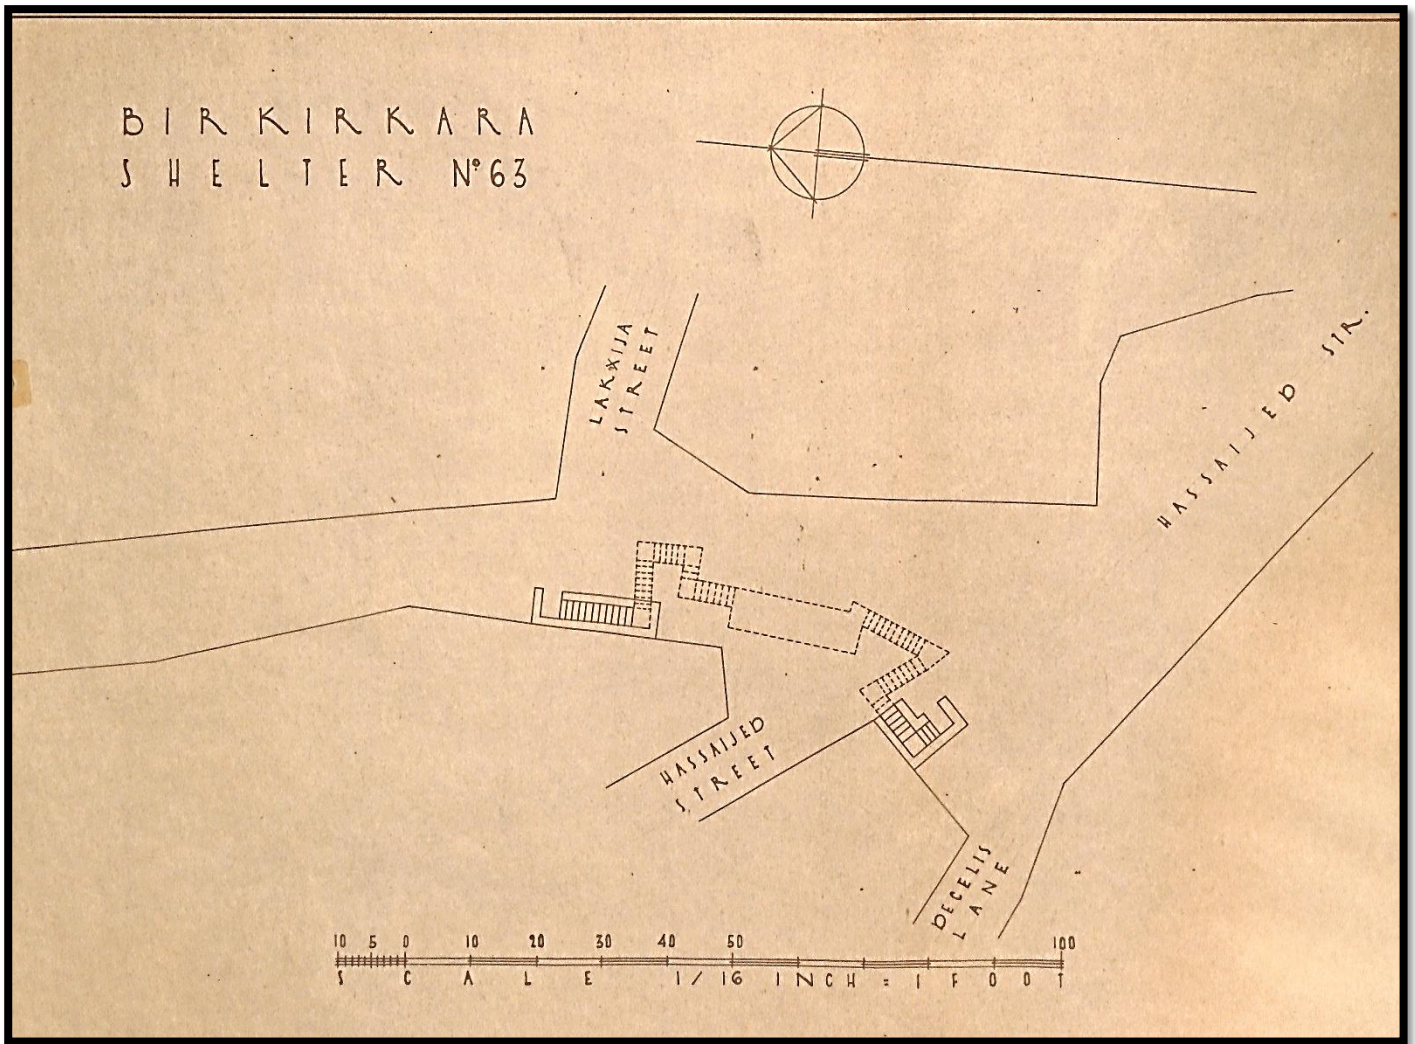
Planta do Abrigo nº63 "Lakkija Street – Hassajjed Street – Bassajjed Str. – Decelis Lane."
